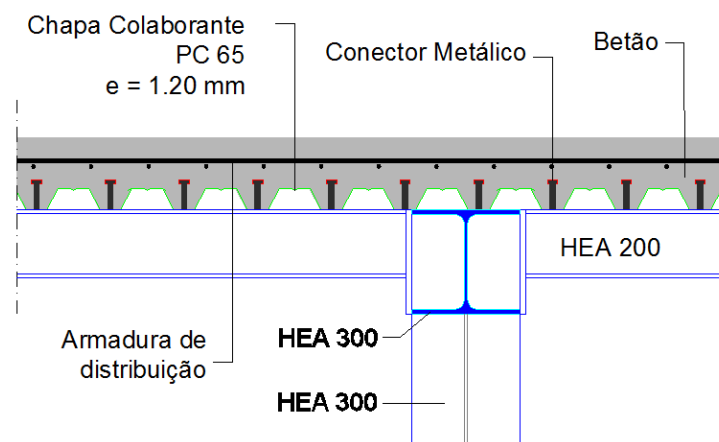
Pormenor construtivo da laje de cobertura (adaptado de [42])
